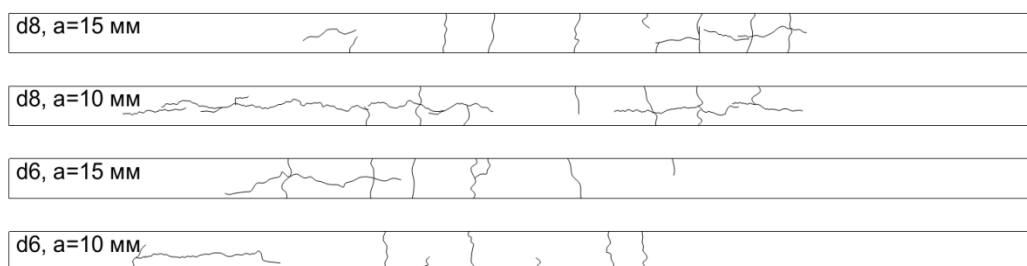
Схемы расположения трещин на нижних гранях железобетонных балок в процессе испытаний
